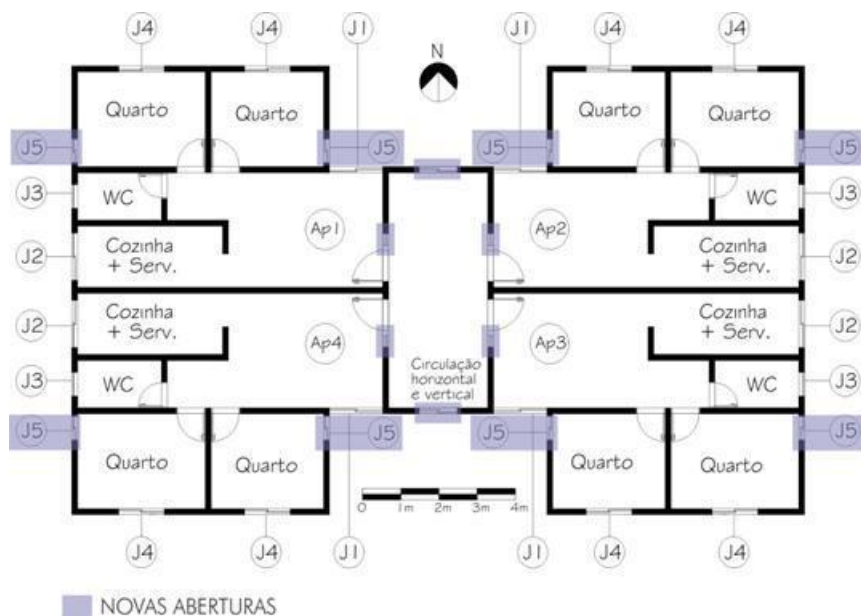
Planta Baixa do Modelo 1 (novas aberturas)
